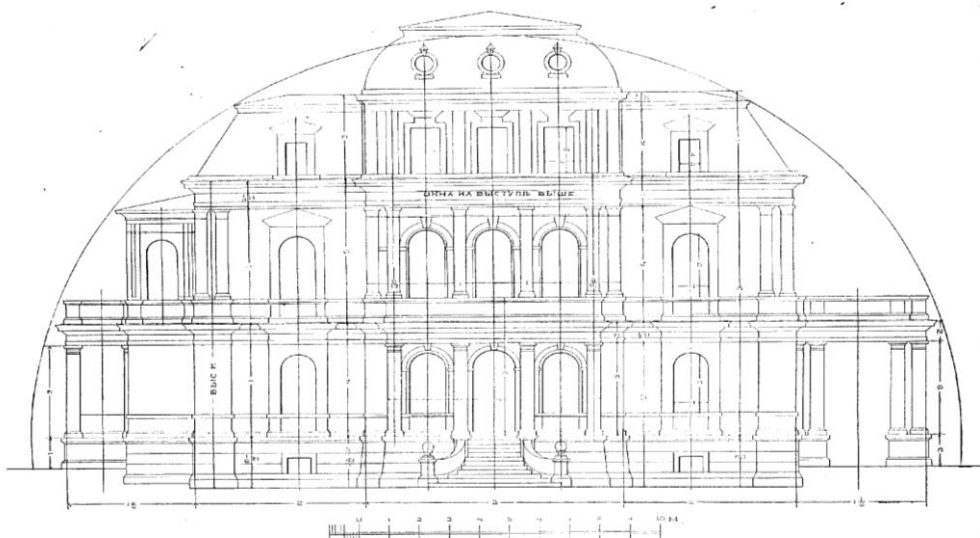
Розбивка фасаду будівлі за кресленнями з [15, Табл.50, Фасада XXX]
